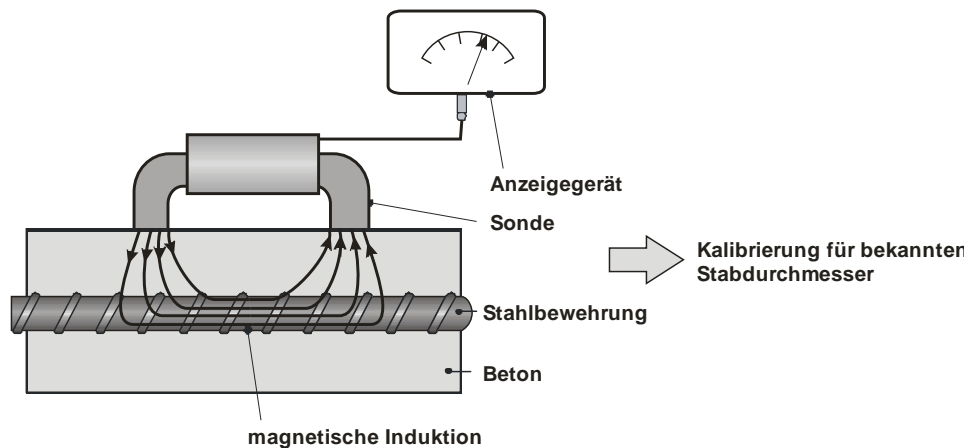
Funktionsprinzip der Betondeckungsmessung nach dem Wirbelstromverfahren
